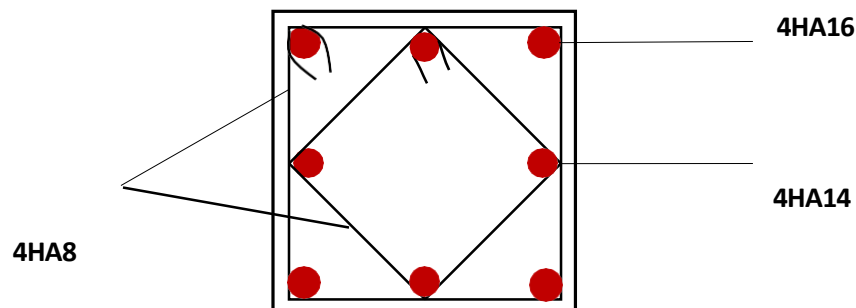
Schéma de ferrailage du poteau 40x40.
